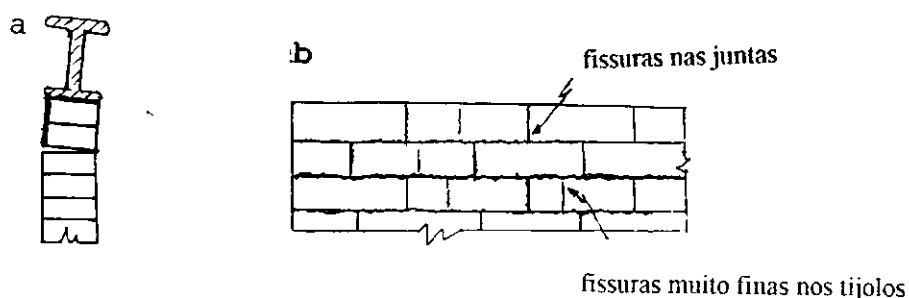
Fissuras na parede sob carga de 155 kN.
